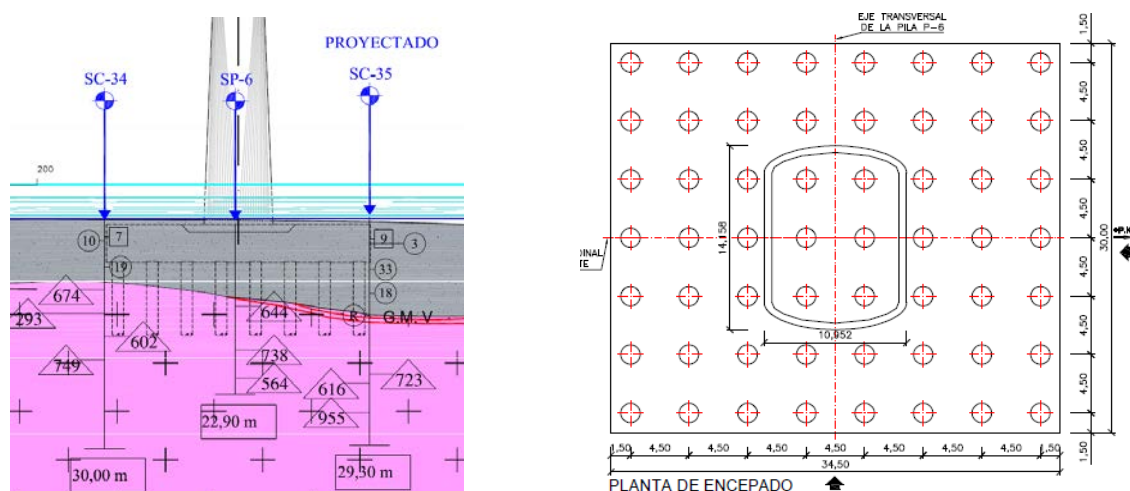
a y b. Perfil geotécnico y planta de pilotes de pila 6
